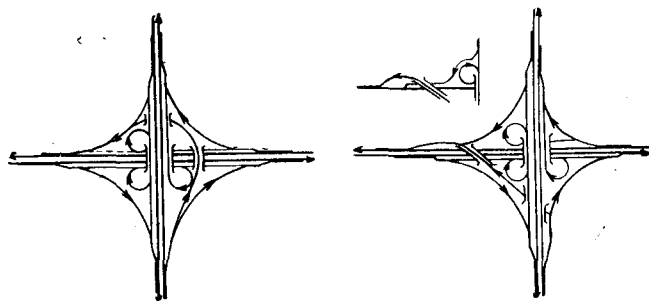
Предлагаемые варианты пересечений типа клеверный лист с дополнительными левоповоротными съездами
